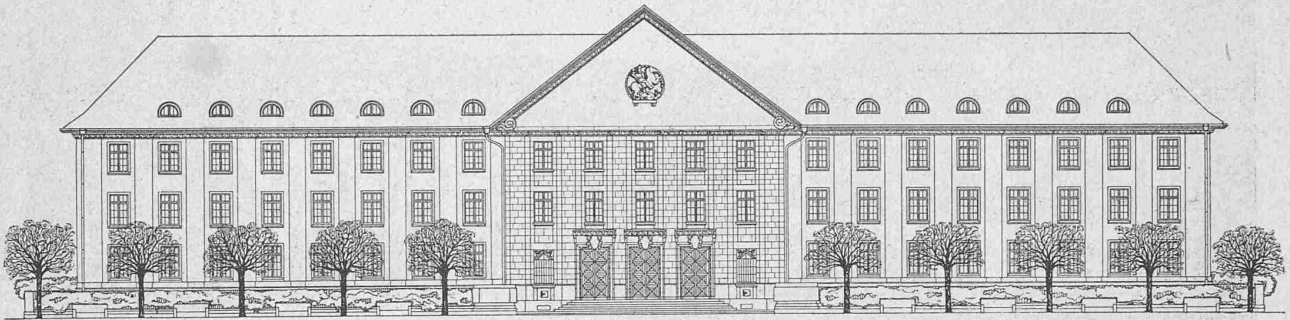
Fassade des Bezirksgerichts-Gebäudes in Zürich mit Haupteingang an der Badenerstrasse. — 1:500.
